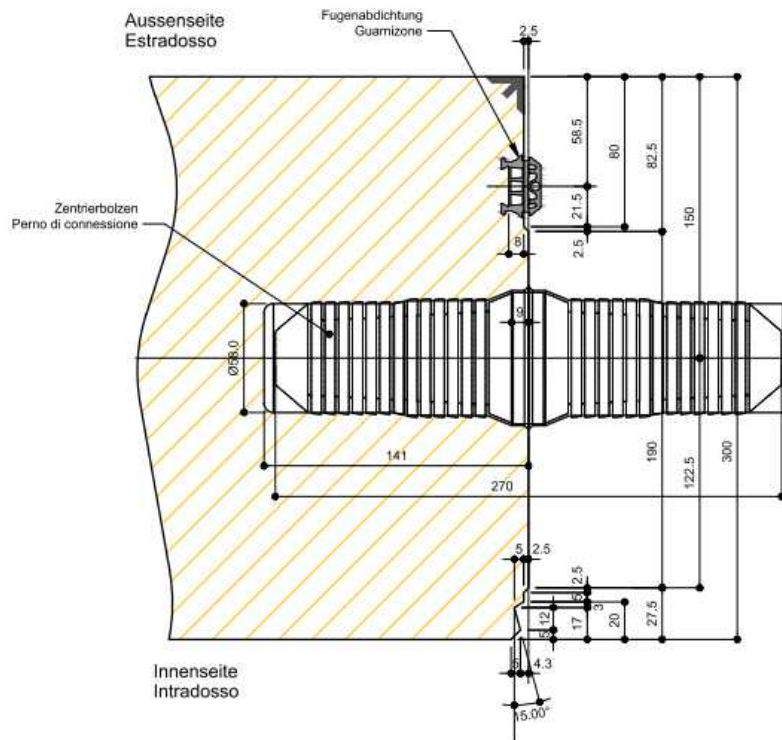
Detail des vorfabrizierten Tübbings mit einfacher Dichtung, Verankerung an die Aussenkante
